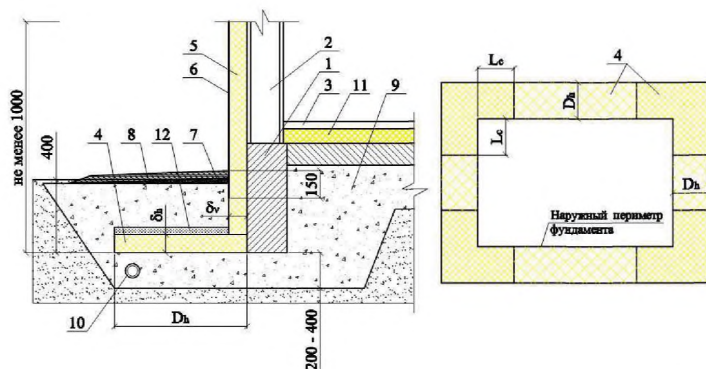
Схема укладки и параметры теплоизоляции в фундаментах отапливаемых зданий с теплоизоляцией пола для жилых, общественных и производственных зданий
